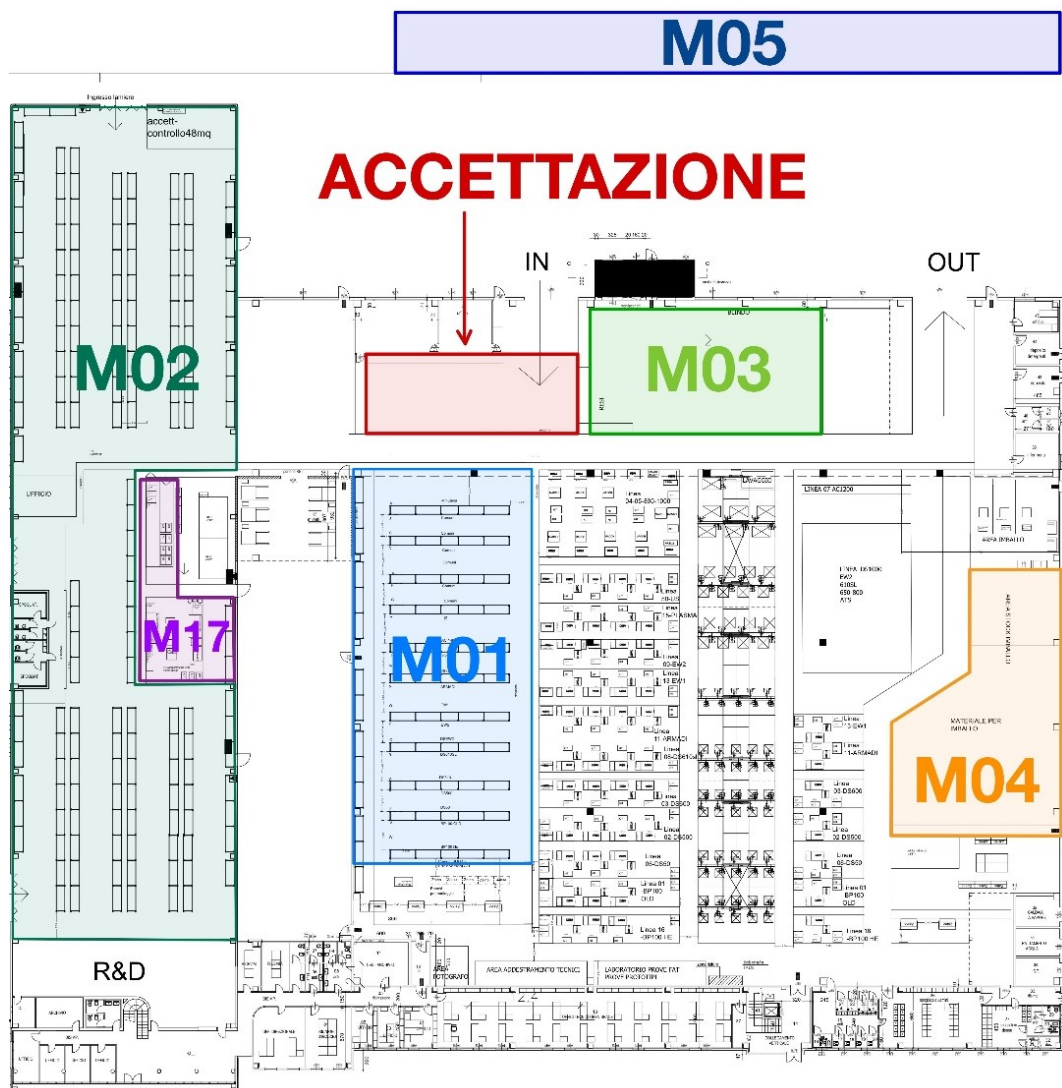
Planimetria dello stabilimento Washer e dettaglio dei magazzini.
